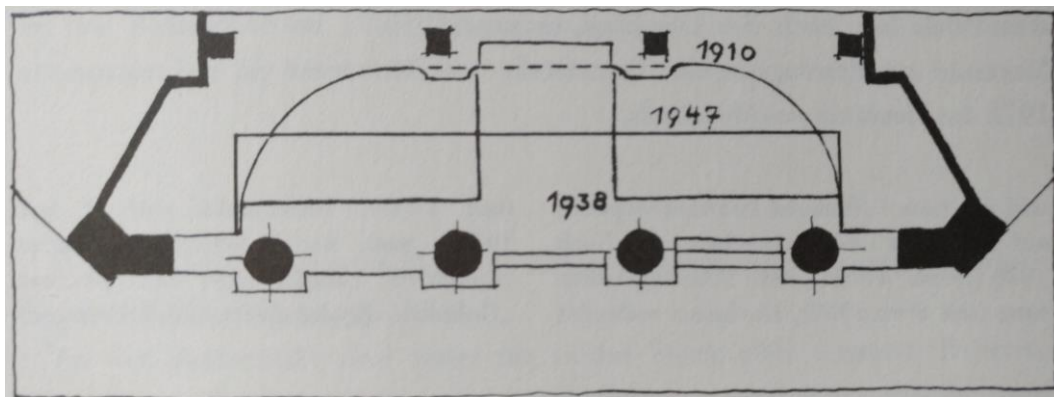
Warenhaus Goldman&Salatsch, Grundriss Schaufensterveränderung, Michaelerplatz, o.J.
